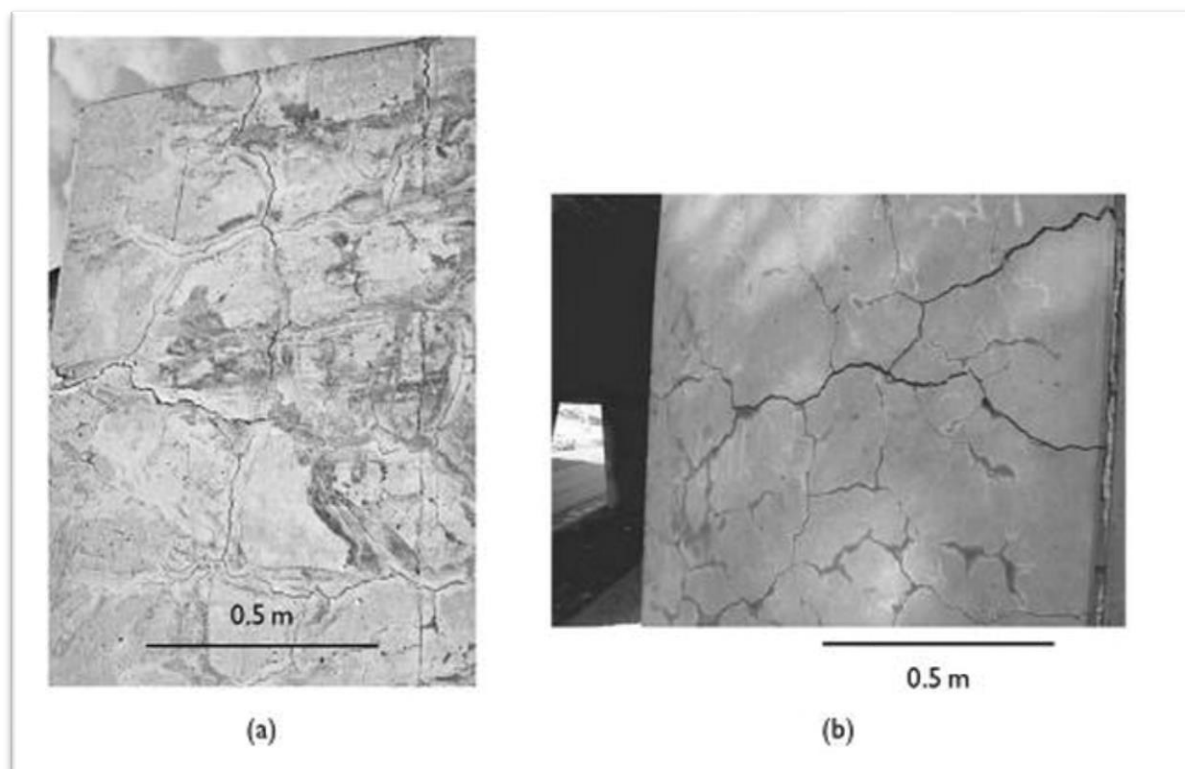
Fissuração em colunas de pontes nos EUA devido RAA, caso A e B
